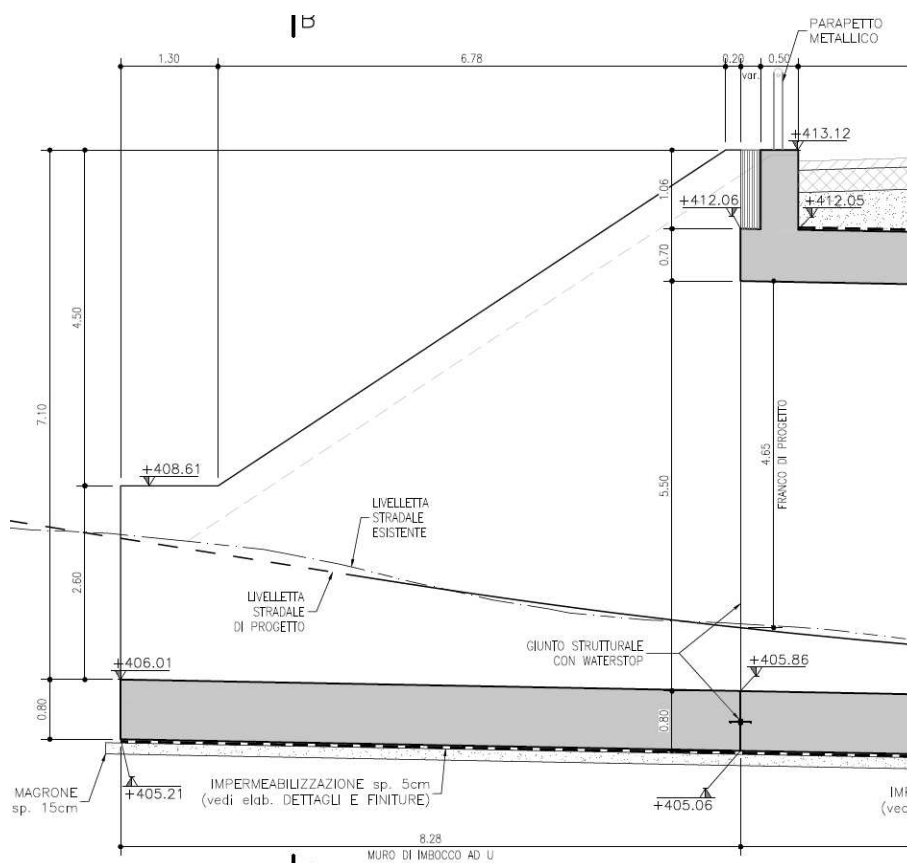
Muri d'imbocco - Sezione longitudinale
